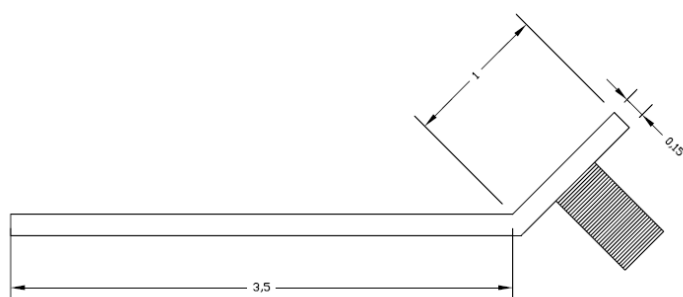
Vista de planta de toma para TNR-1, TNR-2, TNR3 finca UTN sede Guanacaste
